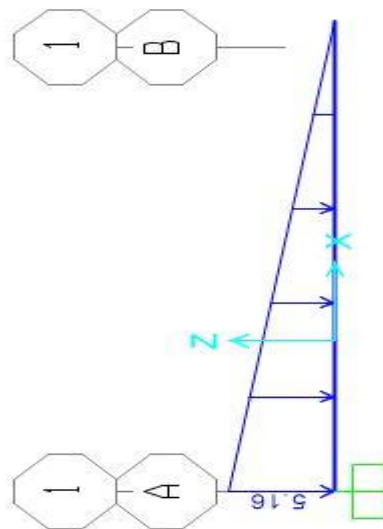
Modelo de pantalla de hormigón Sap2000
